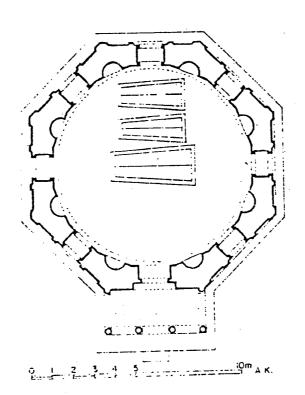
مسقط أفقى لتربة بايزيد يلدريم في بورصة (أوبروسه) (عن : Wilde) .
